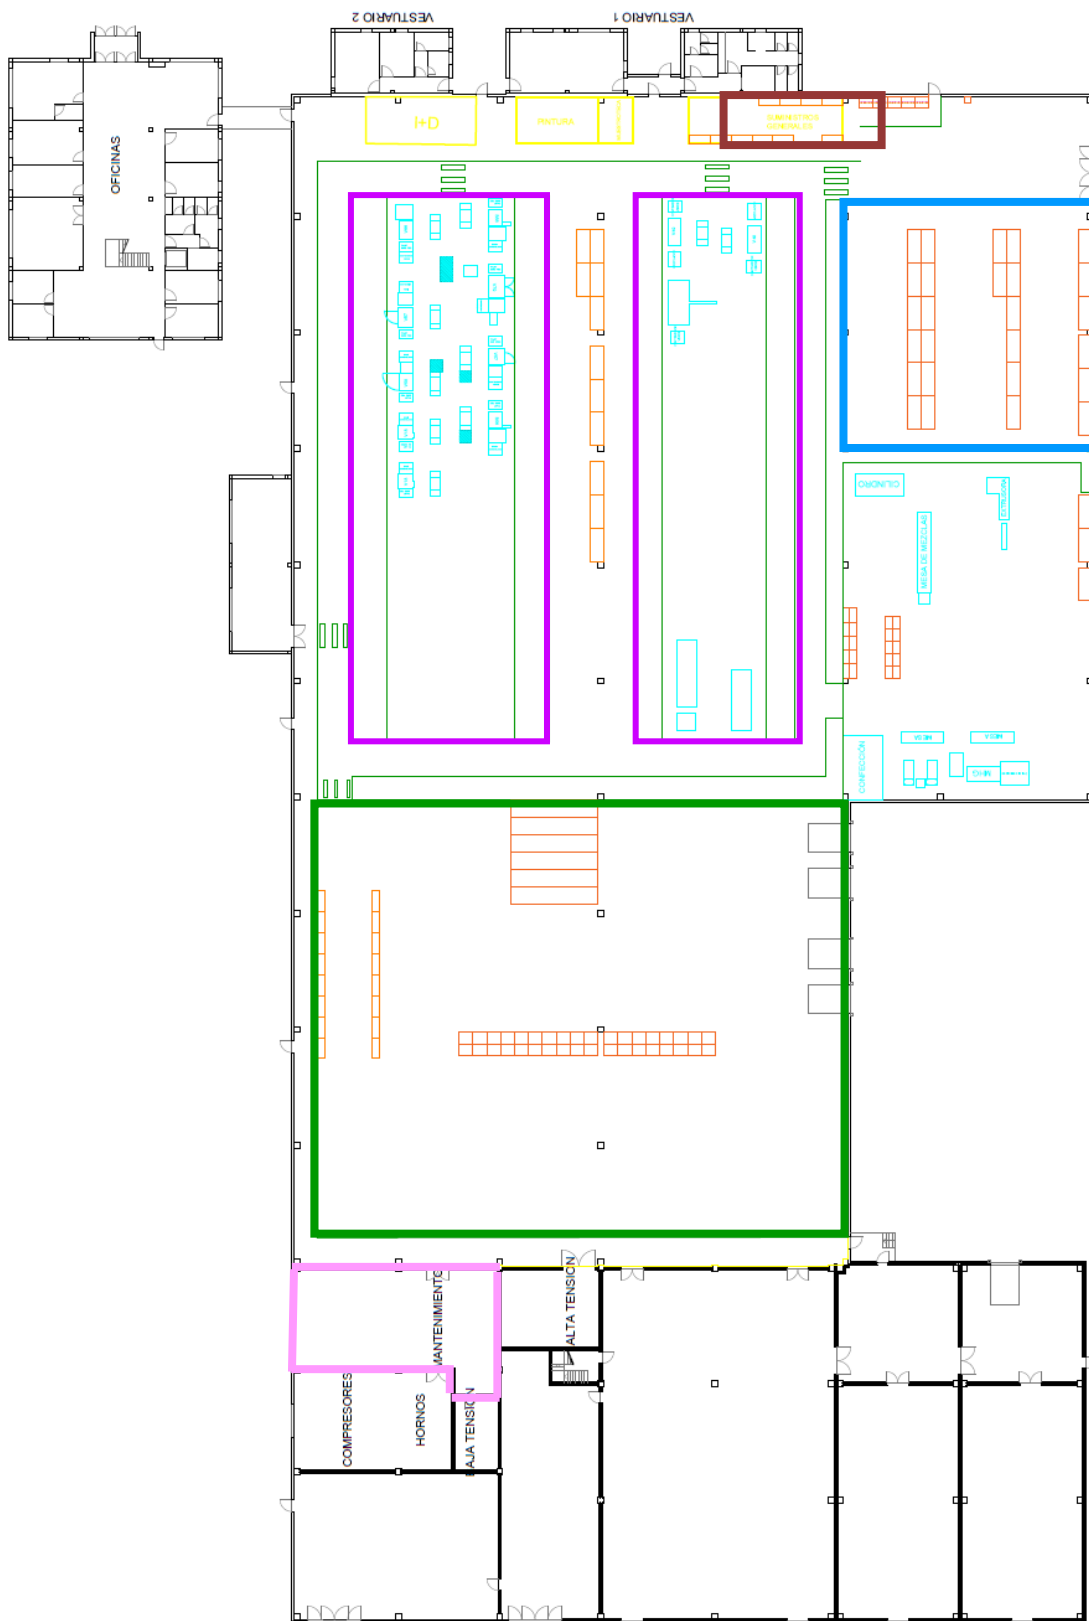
Plano de la planta de la nave. Fuente: Modificado a partir de Vulcanizados Álvarez.
